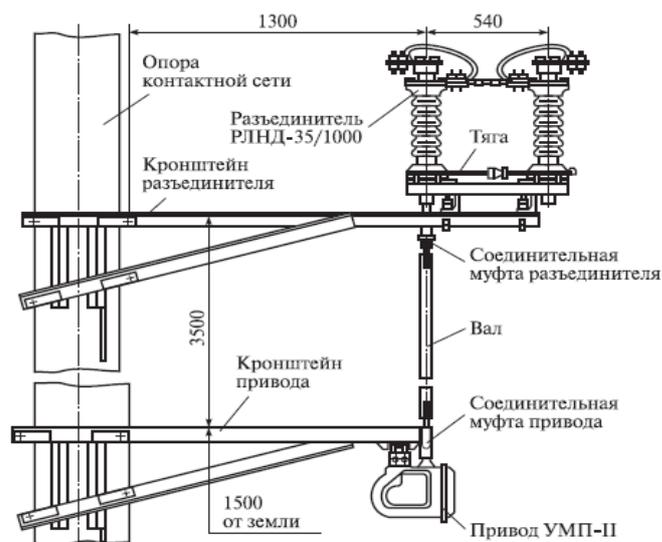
Секционный разъединитель переменного тока РЛНД-35/1000.
